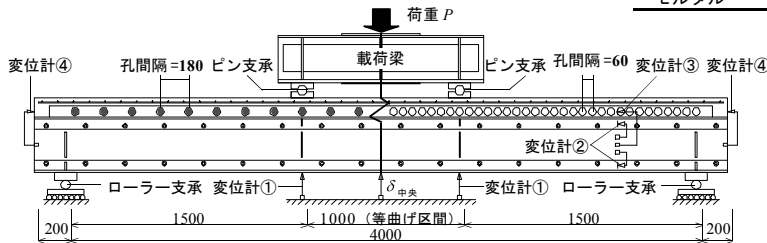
荷重方法・測定方法 (単位: mm) ※右半分に BIC9-24-60, 左半分に BIM9-08-180 試験体を示す
